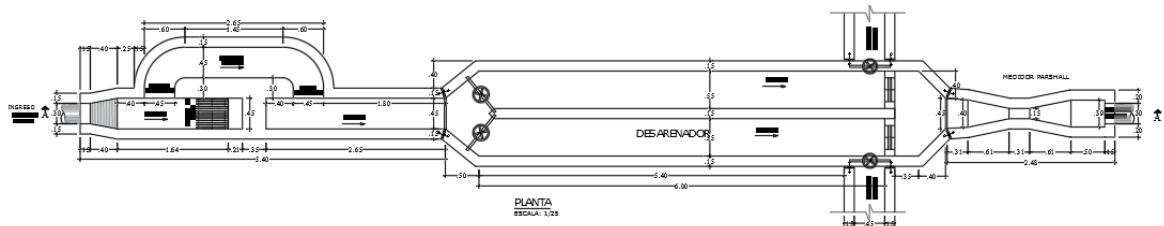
Diseño en Planta Cámara Rejas-Desarenador-Parshall
